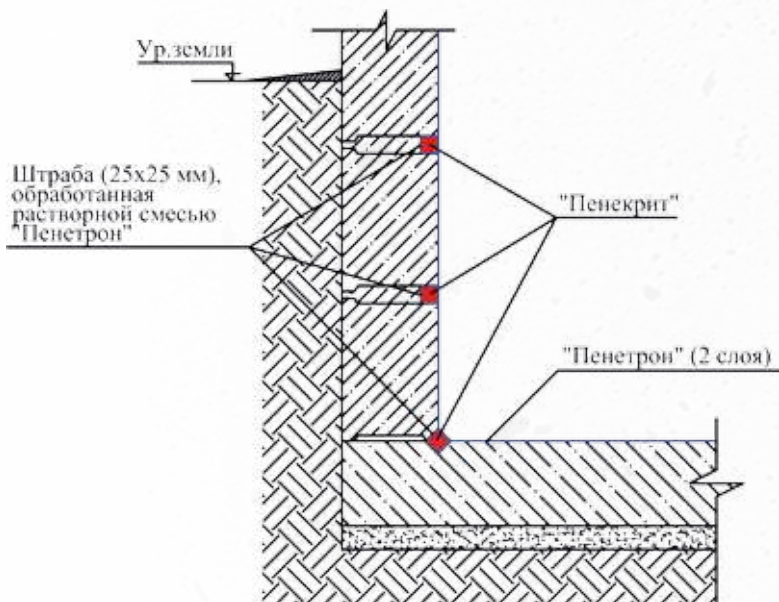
Гидроизоляция фундамента из бетонных блоков
